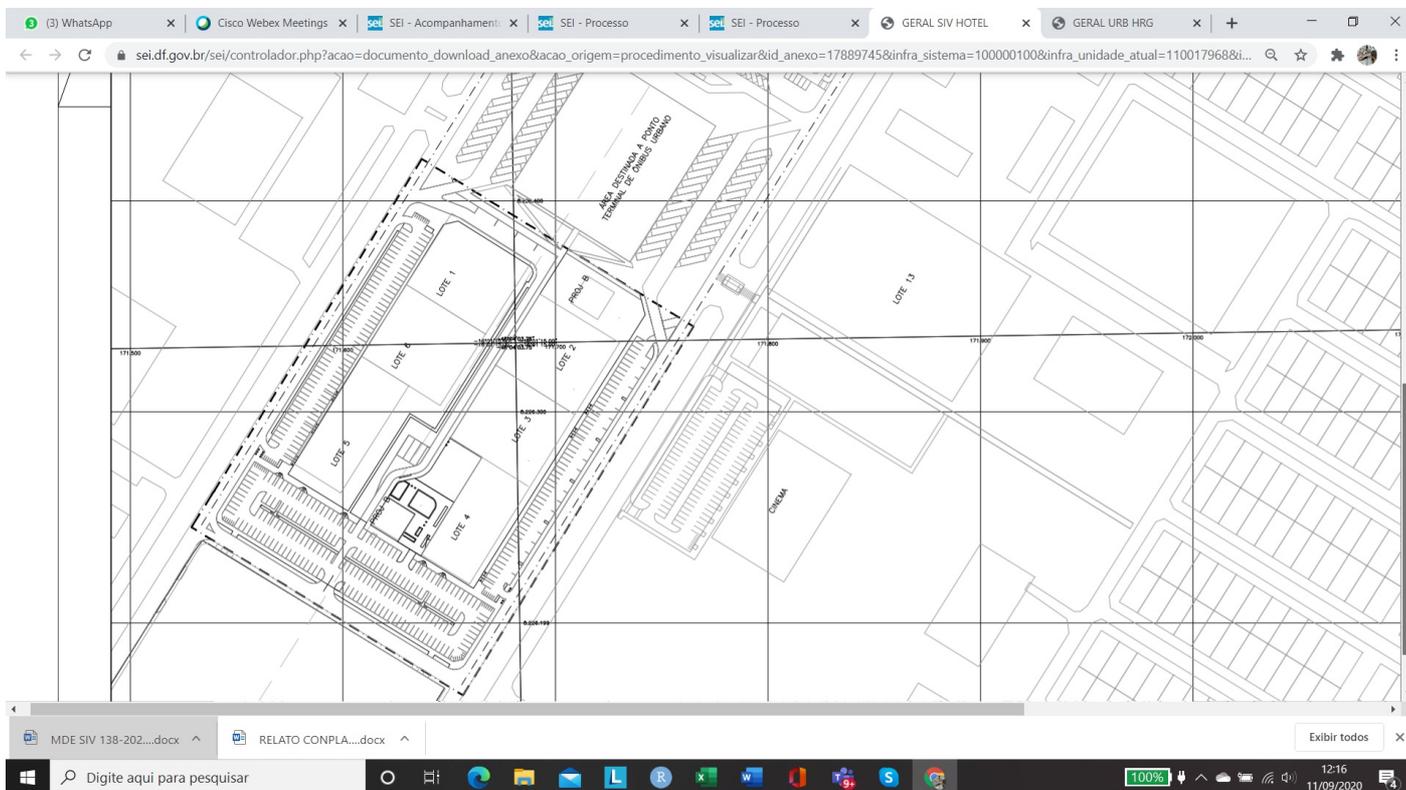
Planta do Projeto de sistema viário e paisagismo do Centro Hoteleiro - SIV 138/2020
